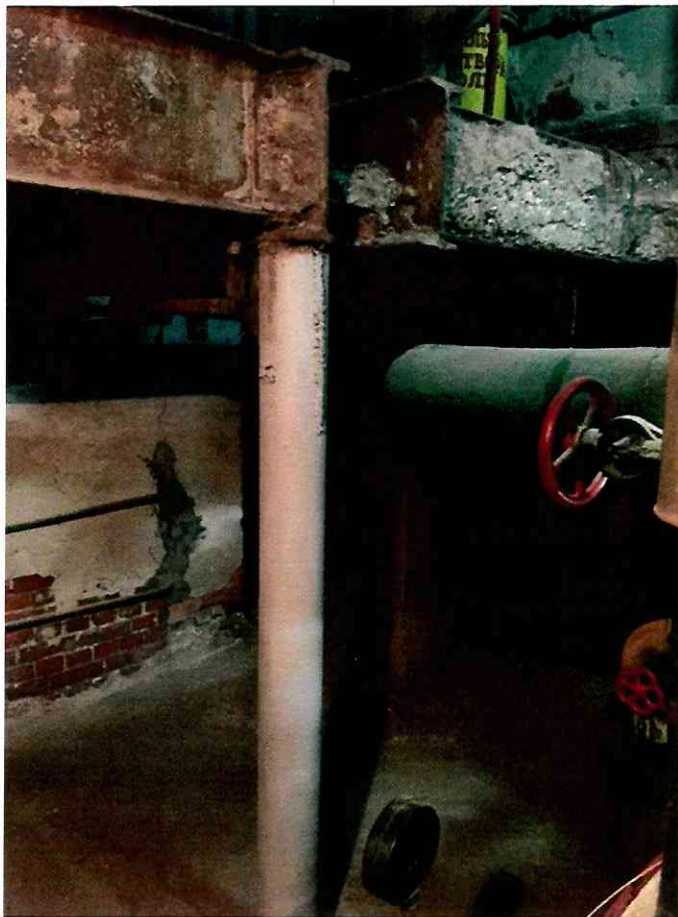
9-10/Д-Ж. Отсутствует опирание балки.
